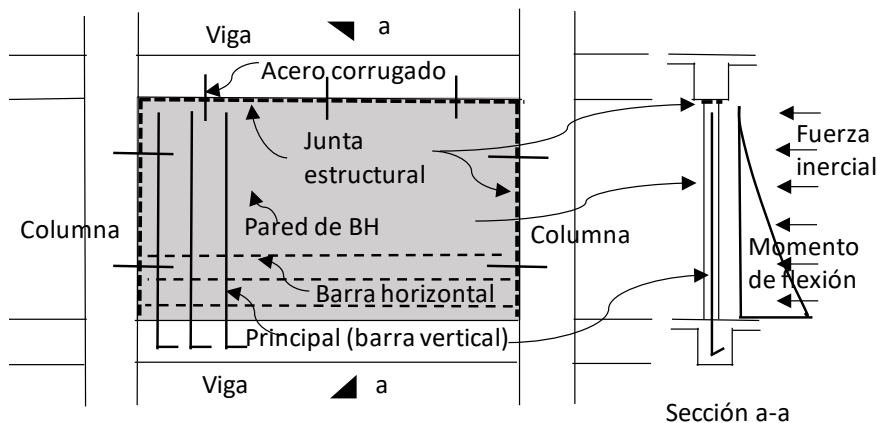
Junta estructural y refuerzo para la pared de BH
